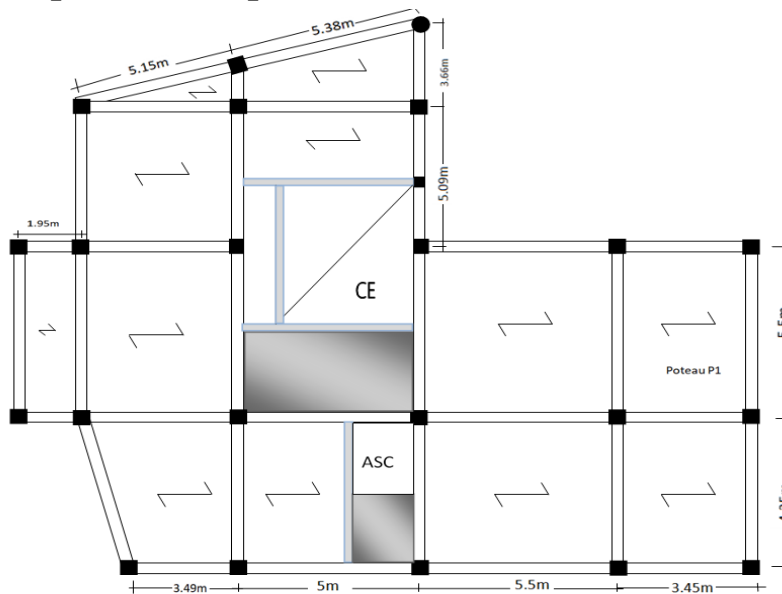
Schéma de disposition des poutrelles du plancher étage courant
